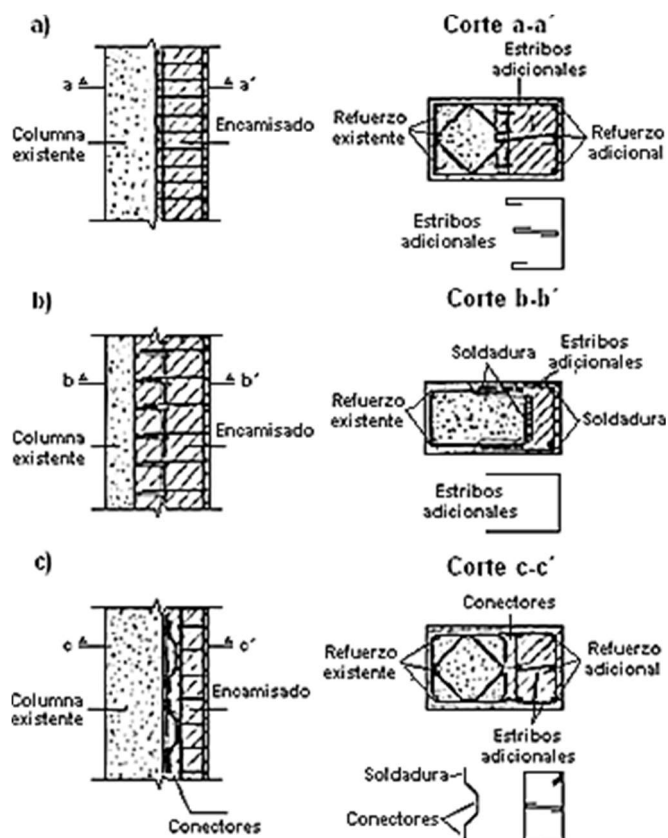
Encamisado parcial de columnas (UNDP/UNIDO, 1983)
